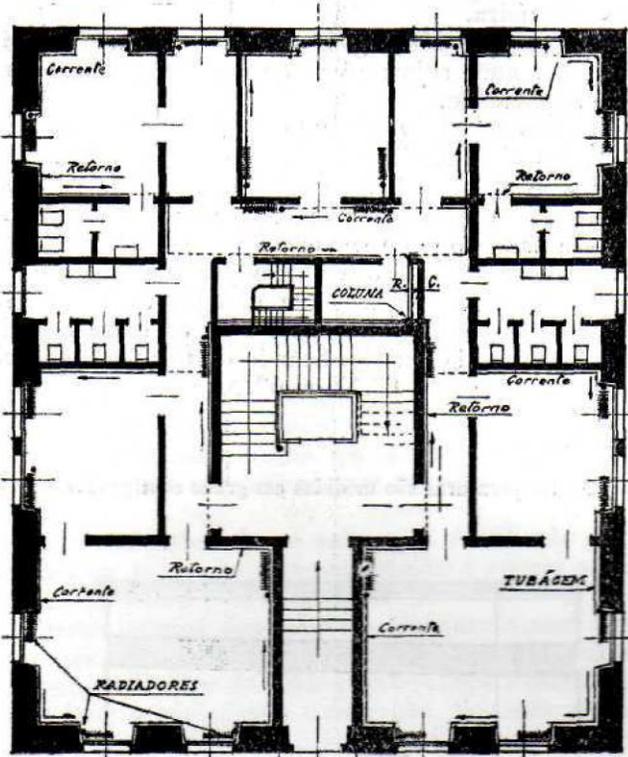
PLANTA DE UMA CASA COM AQUECIMENTO
